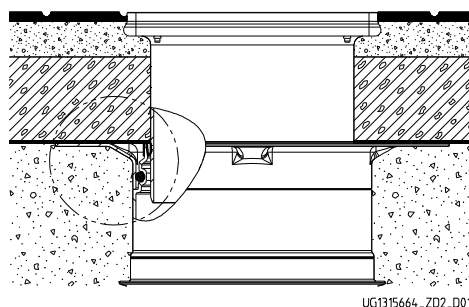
Aufbau mit Dichtungsflansch DF 400
